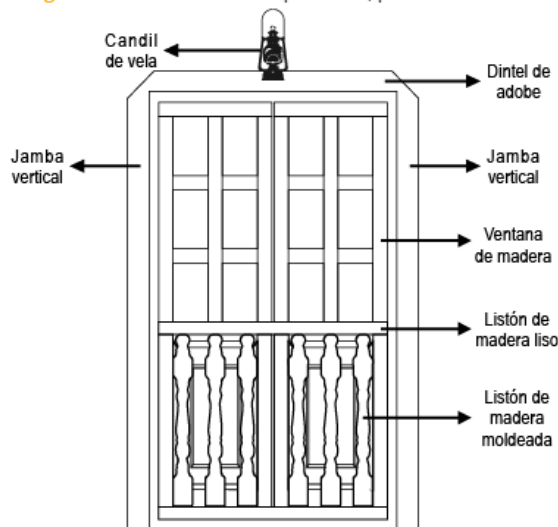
En la ilustración se observa la ventana de la planta alta tipo balcón original de la vivienda con un diseño ecléctico.
